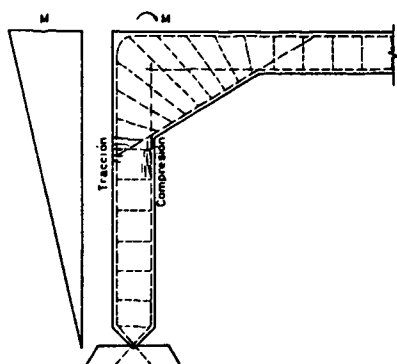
Columna cargada excéntricamente. El efecto del momento, sumado al de la carga, ha producido las grietas indicadas.¹⁰
